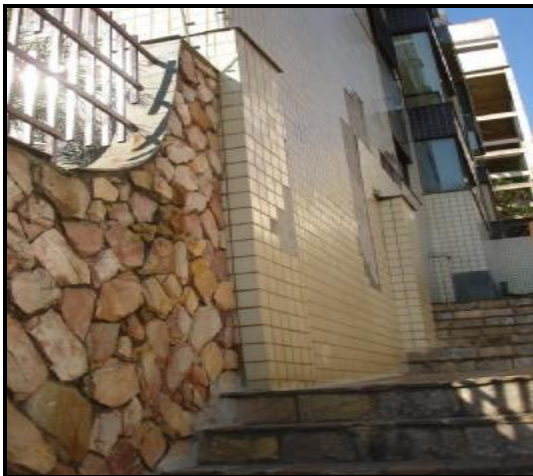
VISTA LATERAL DA FACHADA ESQUERDA DO PRÉDIO EM LÍTIPIO. NOTAR DESPLACAMENTO EM PEÇA ESTRUTURAL.
